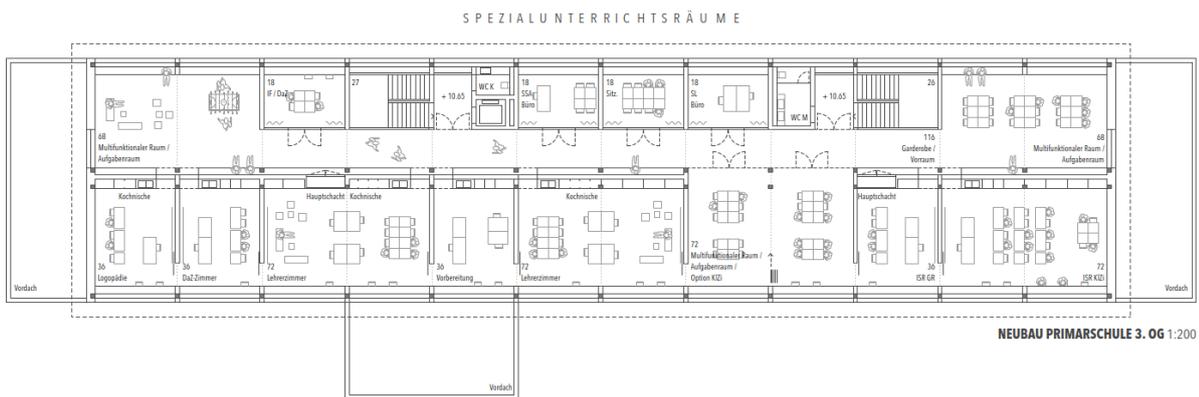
Grundriss Neubau Primarschule, 3. Obergeschoss
